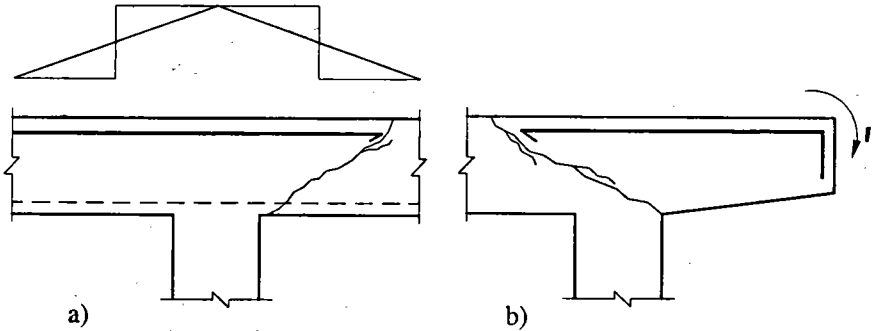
Neo cốt thép chịu kéo vào nút cứng
